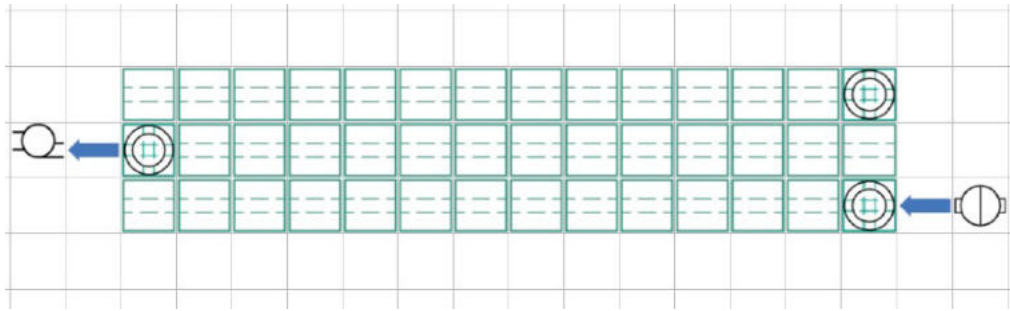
Ausschnitt aus Musterberechnung Rigolenanlage 24 m³; (Fränkische, Drainagesysteme 11/2025), Darstellung unmaßstäblich
